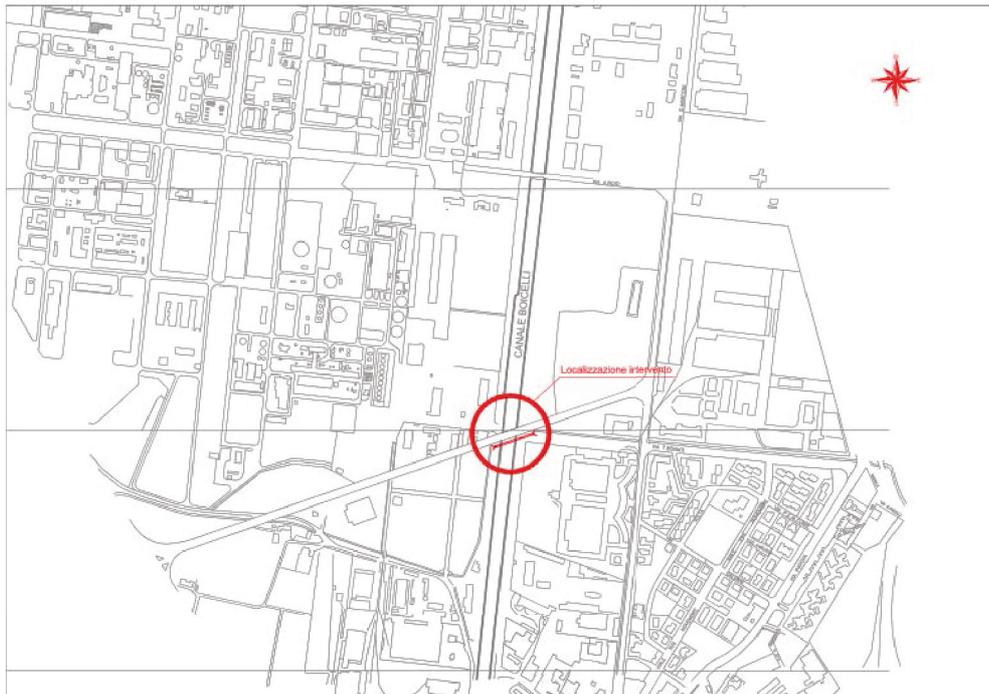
Posizionamento dell'area di intervento (Archivio MCE 2016)
